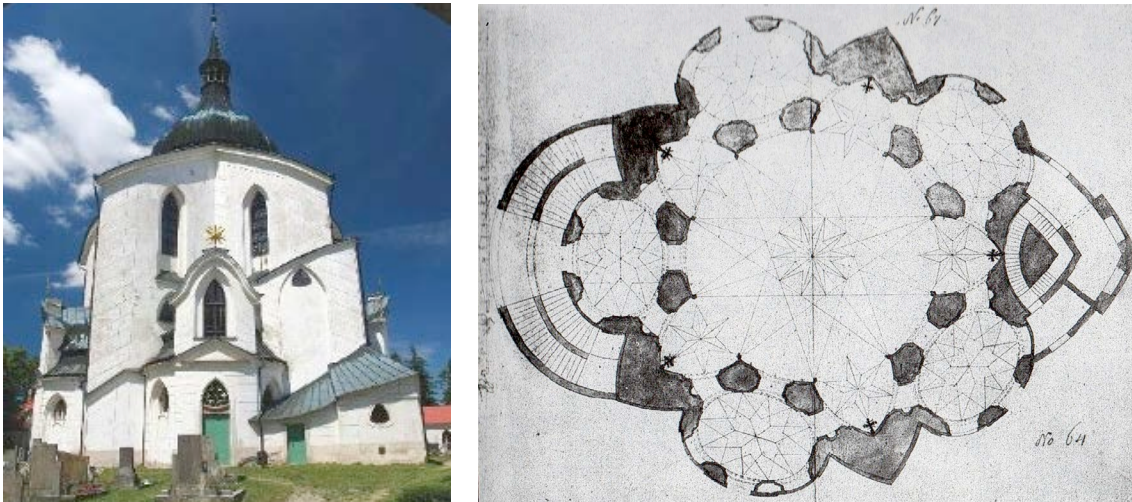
Jan Blažej Santini-Aichel, Wallfahrtskirche des Hl. Johannes von Nepomuk auf dem Grünen Berg, Tschechien, 1719-1722, Ansicht und Grundriss
